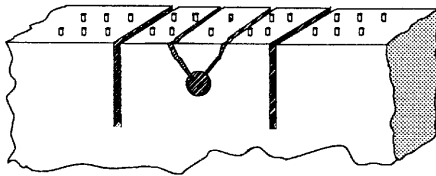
Presswerkzeuge zu nahe an der Oberfläche
